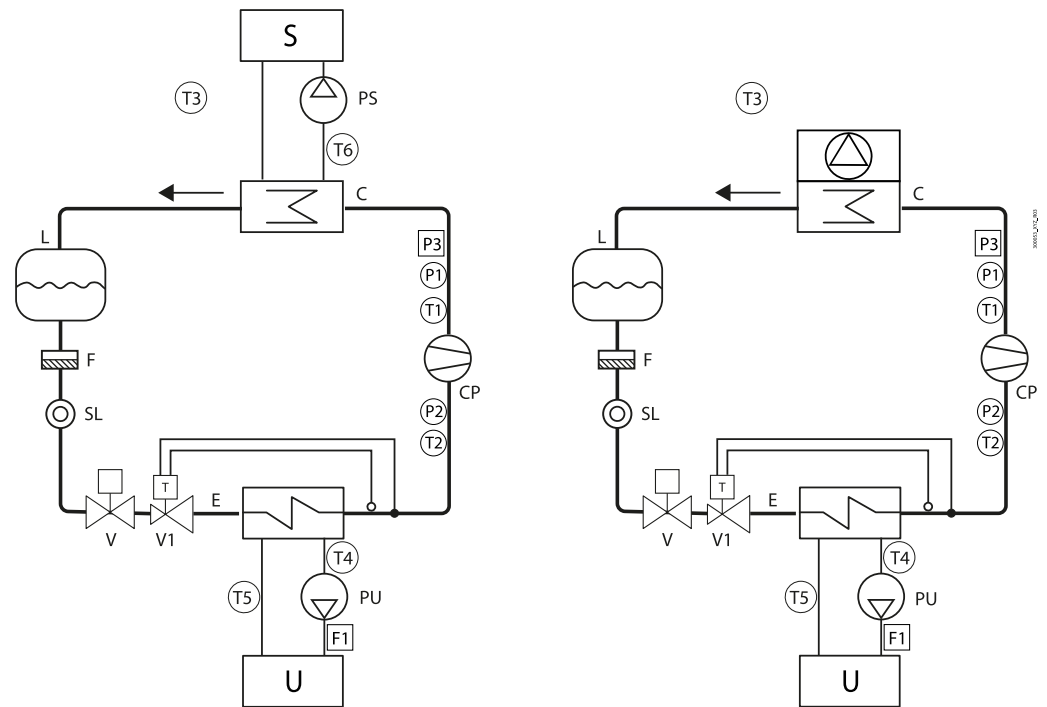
r: wassergekühltes Gerät (links) und luftgekühltes Gerät (rechts)
